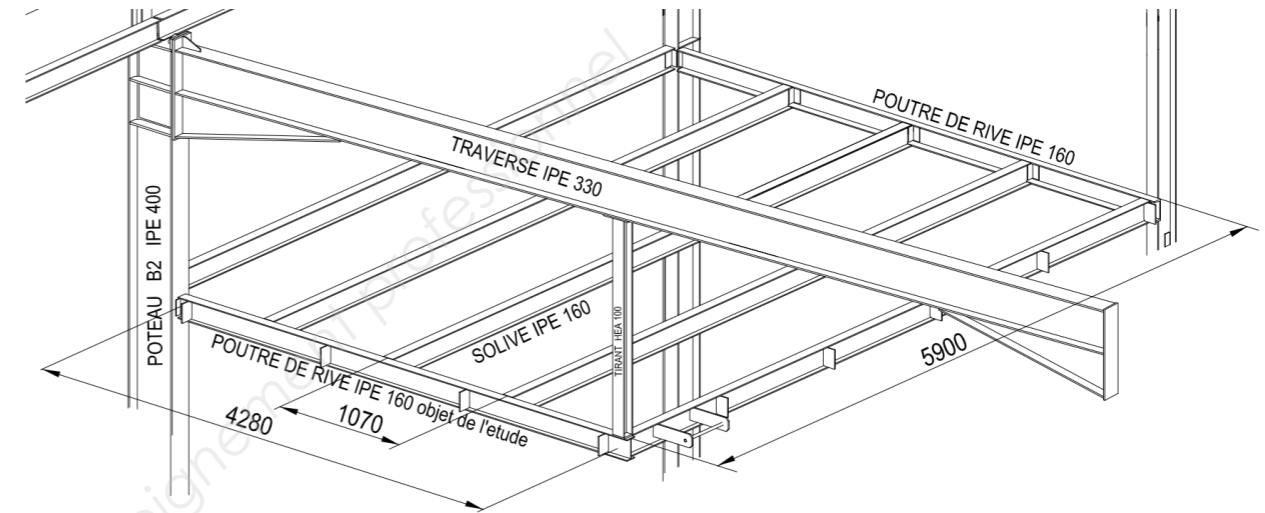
Vue de détail de la poutraison de la mezzanine supportant le plancher en cailleboti avec au premier plan la poutre de rive objet de l'étude. Elle est rattachée au poteau et à la traverse de la file 2.
